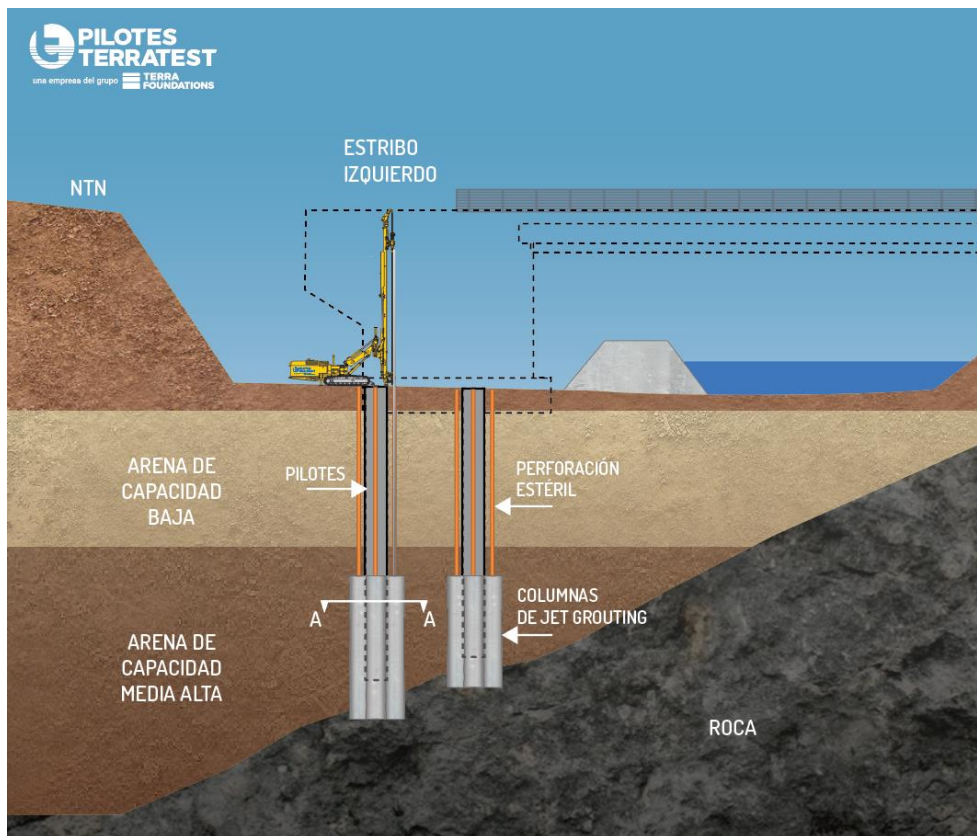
Proyección de columnas de *Jet grouting* ejecutadas en el estribo sur.
